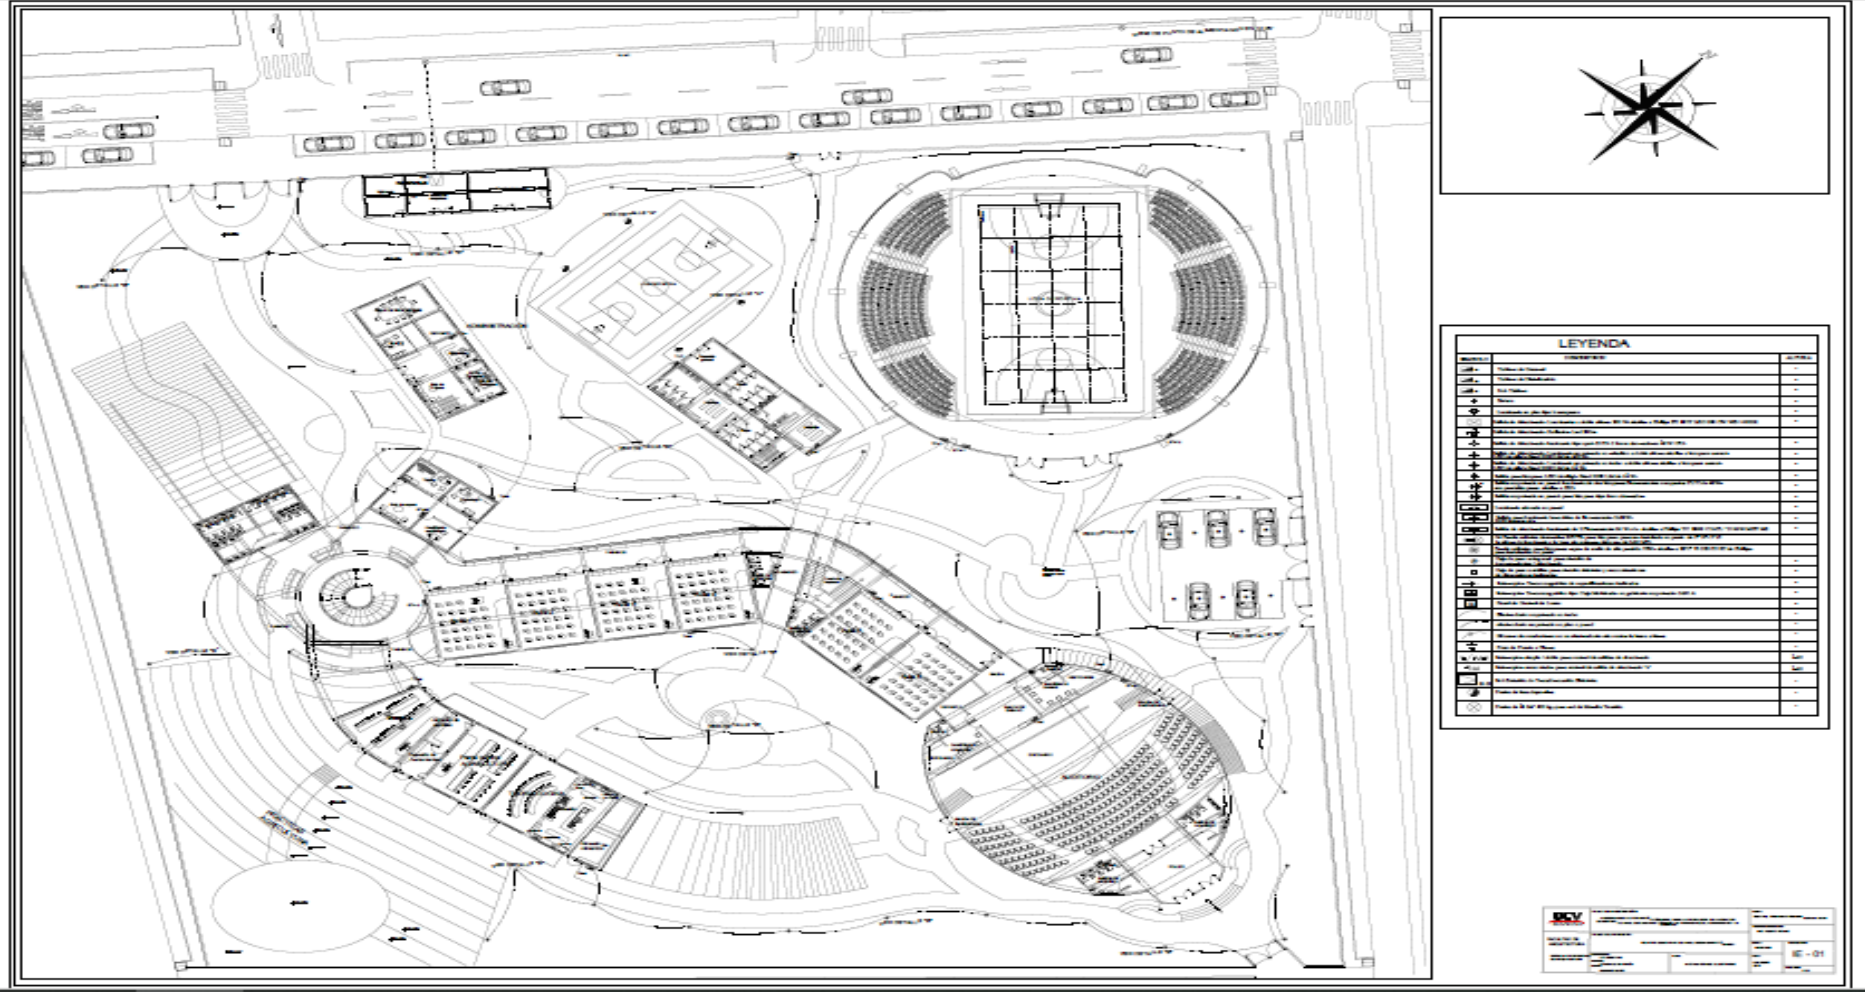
Plano de Diseño de Instalaciones Básicas – Eléctricas - Plano N° 33 - Lamina IE-01
